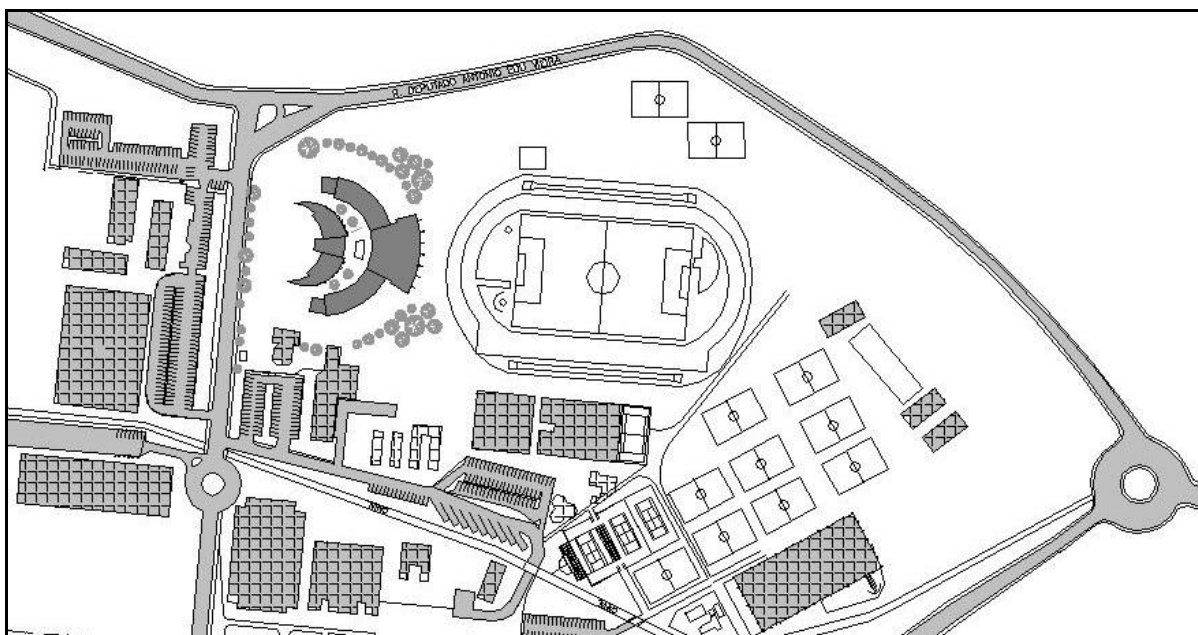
Planta de situação da área de estudo com a nova edificação.
